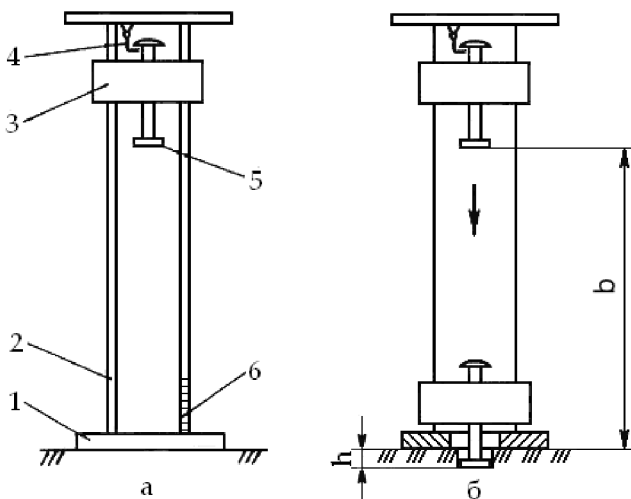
Ударник конструкції Олександра Броварця TSM 4.1: *a* — загальний вигляд; *б* — схема дії; 1 — опора; 2 — стовп; 3 — рухомий вантаж; 4 — тримач; 5 — плунжер; 6 — лінійка
